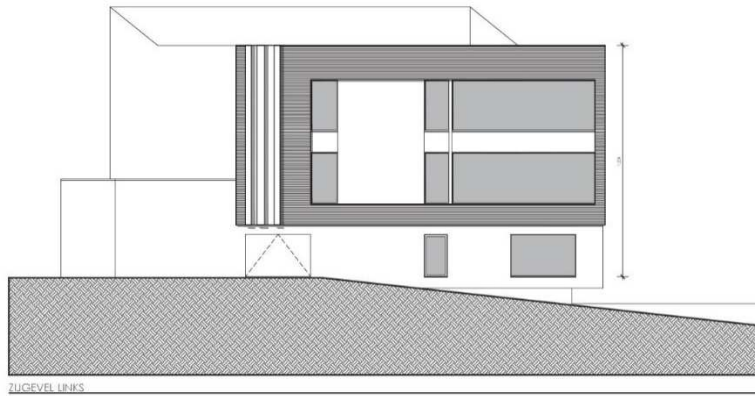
Lokalisatie van de werkzaamheden ( De Clippel-Michiels architecten, tijdelijke vereniging. Voor een gedetailleerde versie : zie bijlage plan 1).
